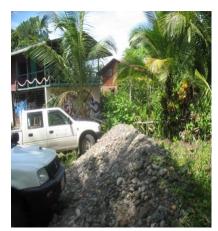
Casa 50% construcción. Foto 3. Casa 10% construcción
